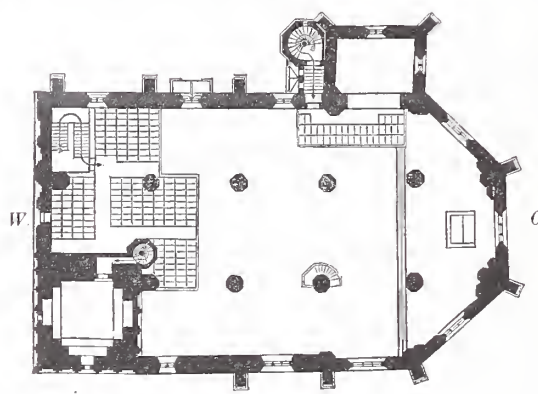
Oberer Grundriss mit den geplanten Emporen.
